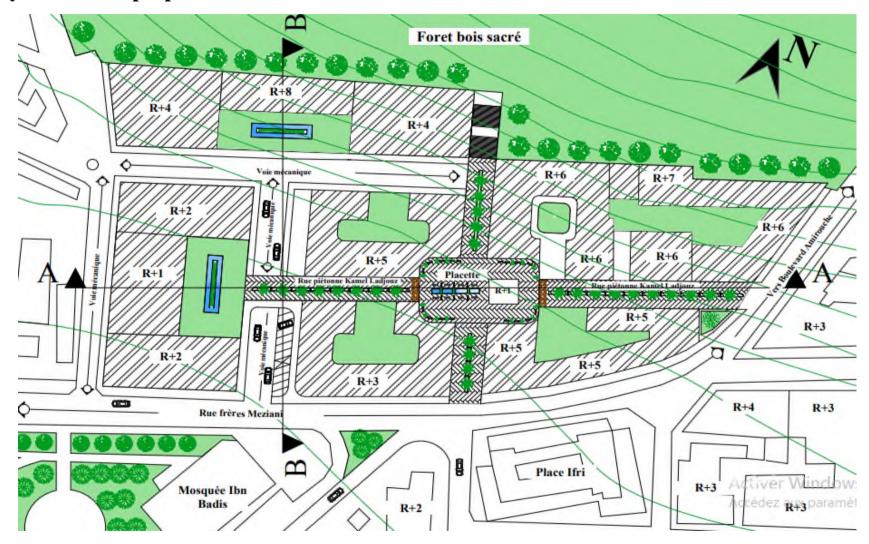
Plan de la proposition urbaine (Source : Auteur)
